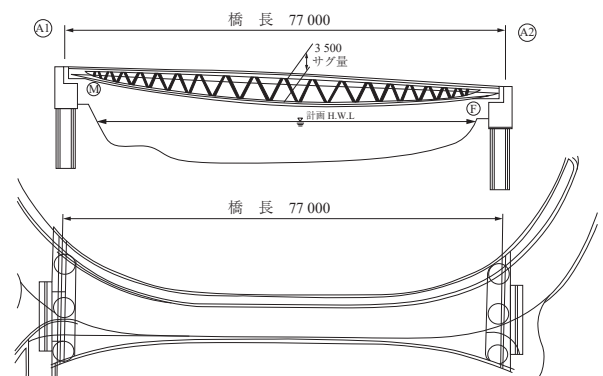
白虹橋の断面図³⁾図 - 3 白虹橋の側面図と平面図³⁾
